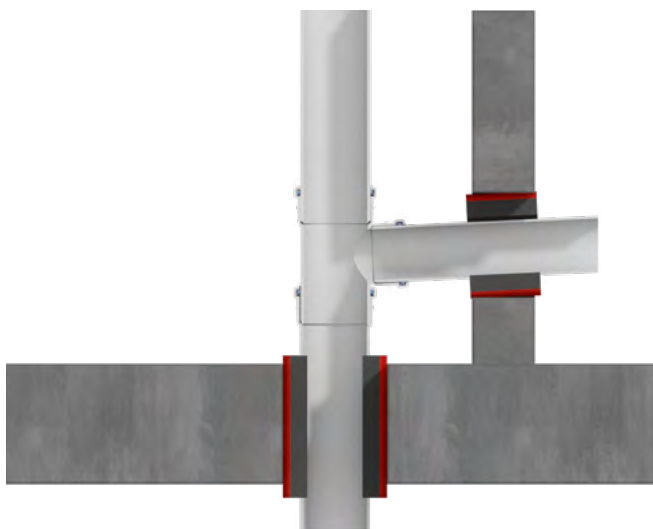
Decken- und Wanddurchführungen Wavin AS+
